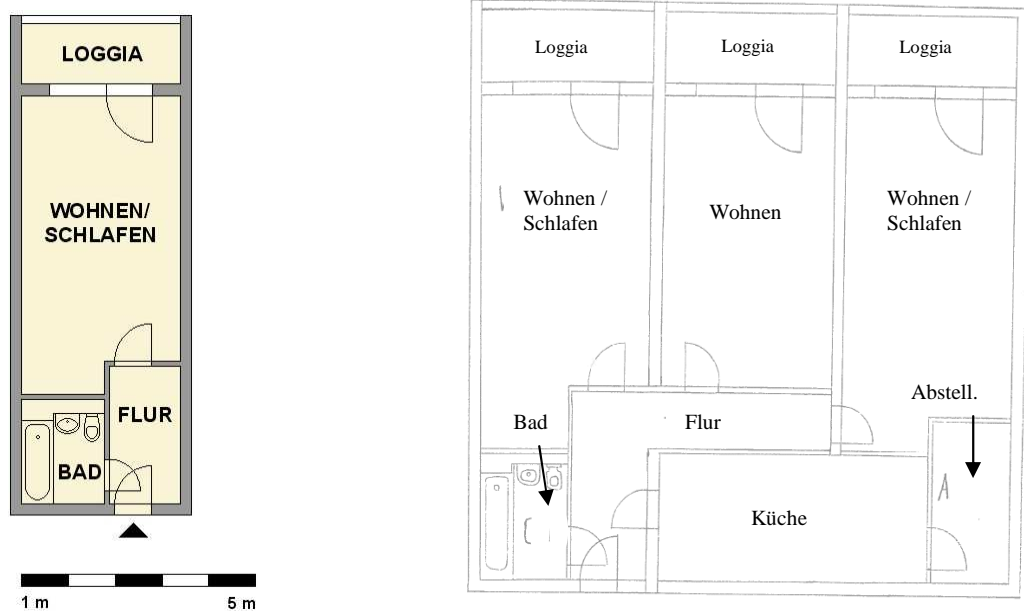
Grundrissänderungen für die 3-Raum-Wohngemeinschaft
